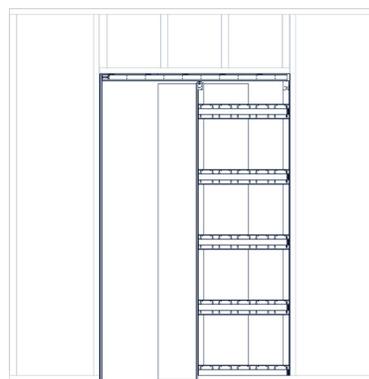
Schiebetür-Einbauelement für die Trockenbauwand. Der Bausatz enthält sämtliches Zubehör für die Montage.
